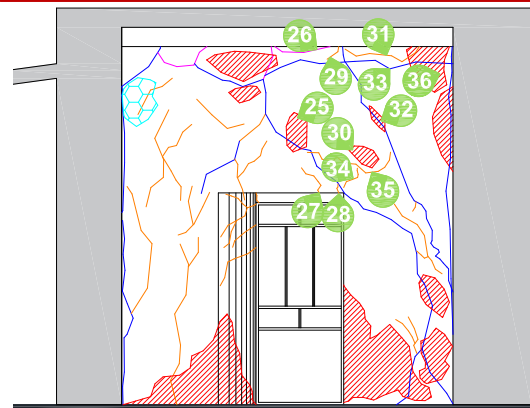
Fisuras y agrietamientos en muro interior norte
